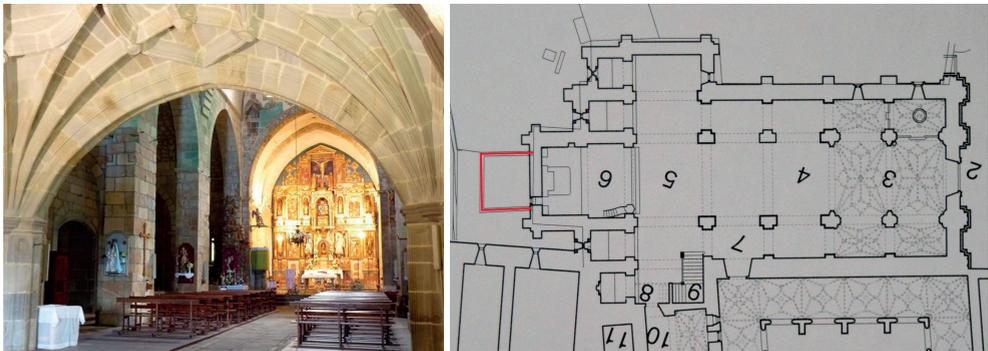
Santa María de Oia (Pontevedra). Acceso interior y localización de la planta de la chirola
